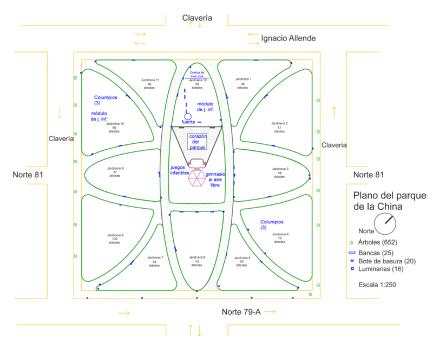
Plano del parque de la China. (Elaboración propia en AutoCAD.)
